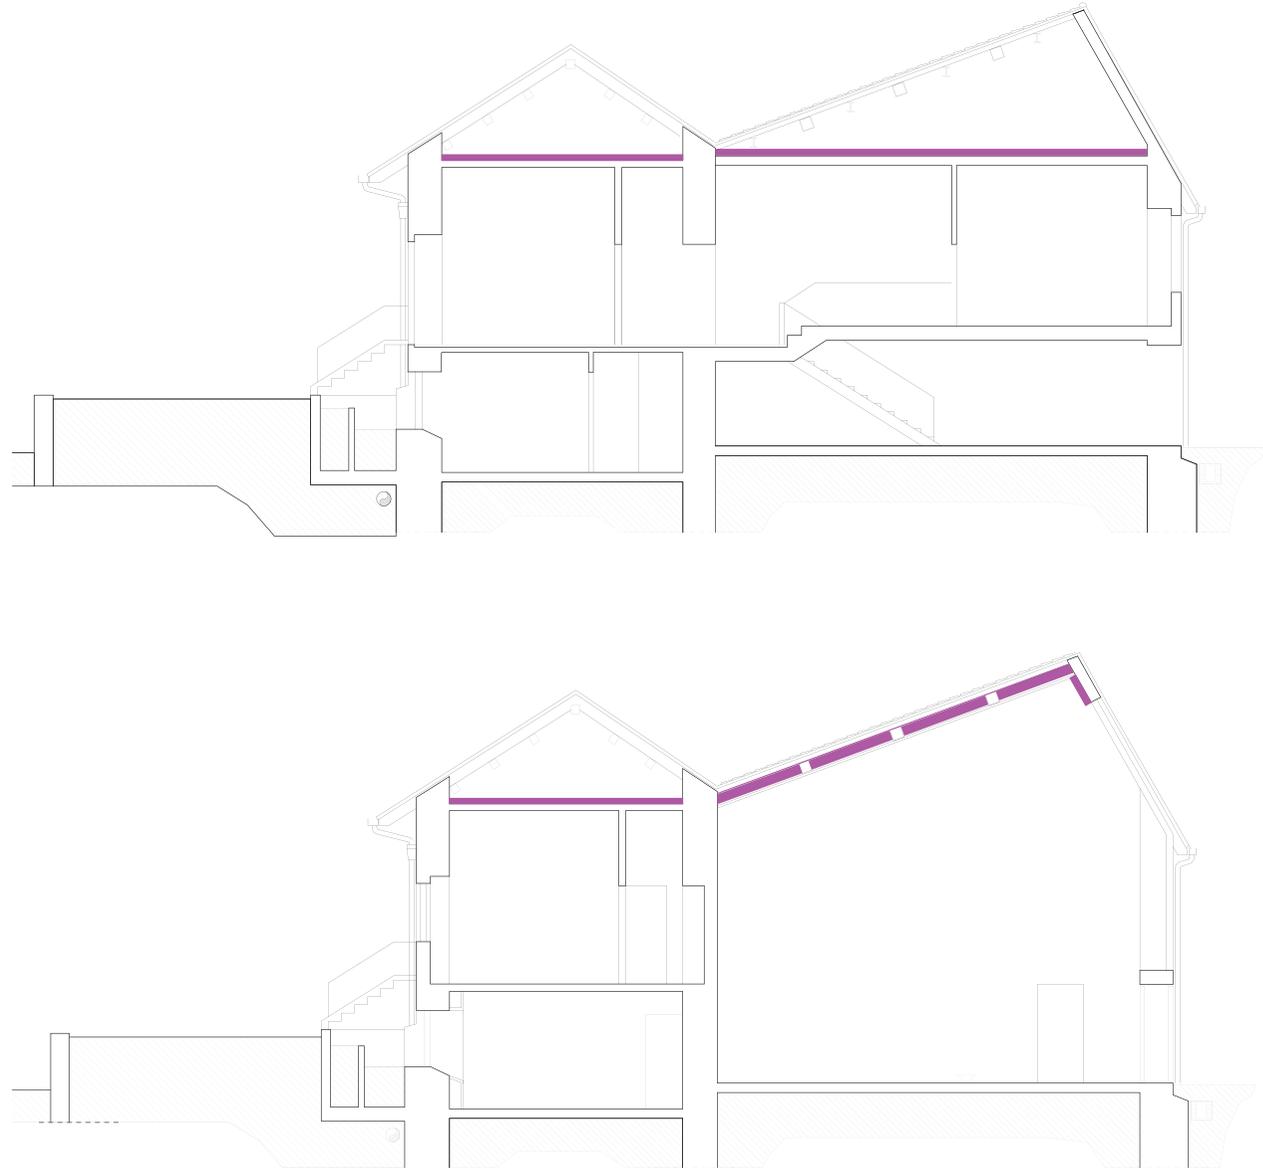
Maßnahme Dämmung Dach bzw.oberste Geschossdecke Studios
